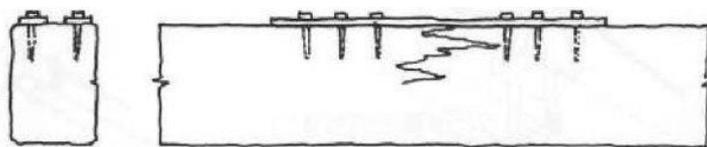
Reforço de viga através da colocação de chapa metálica na face superior (Arriaga, 2002)
